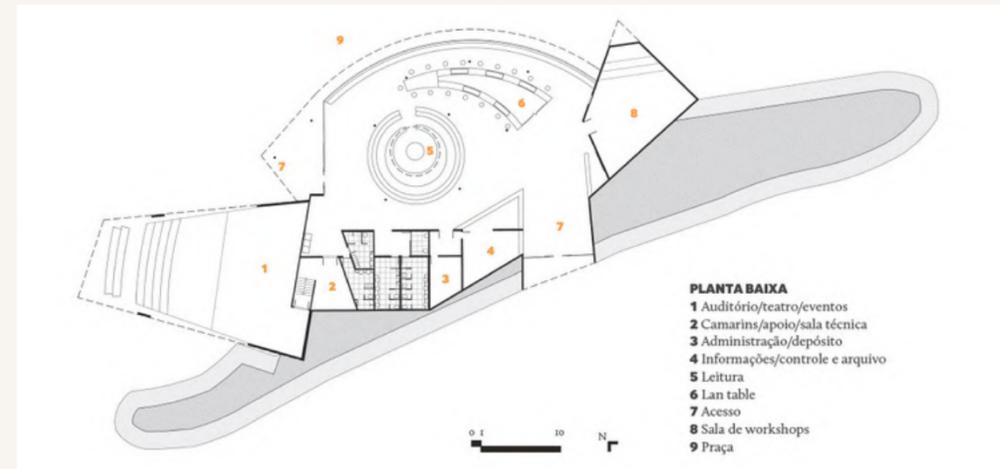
Planta da Praça do Conhecimento de Padre Miguel
